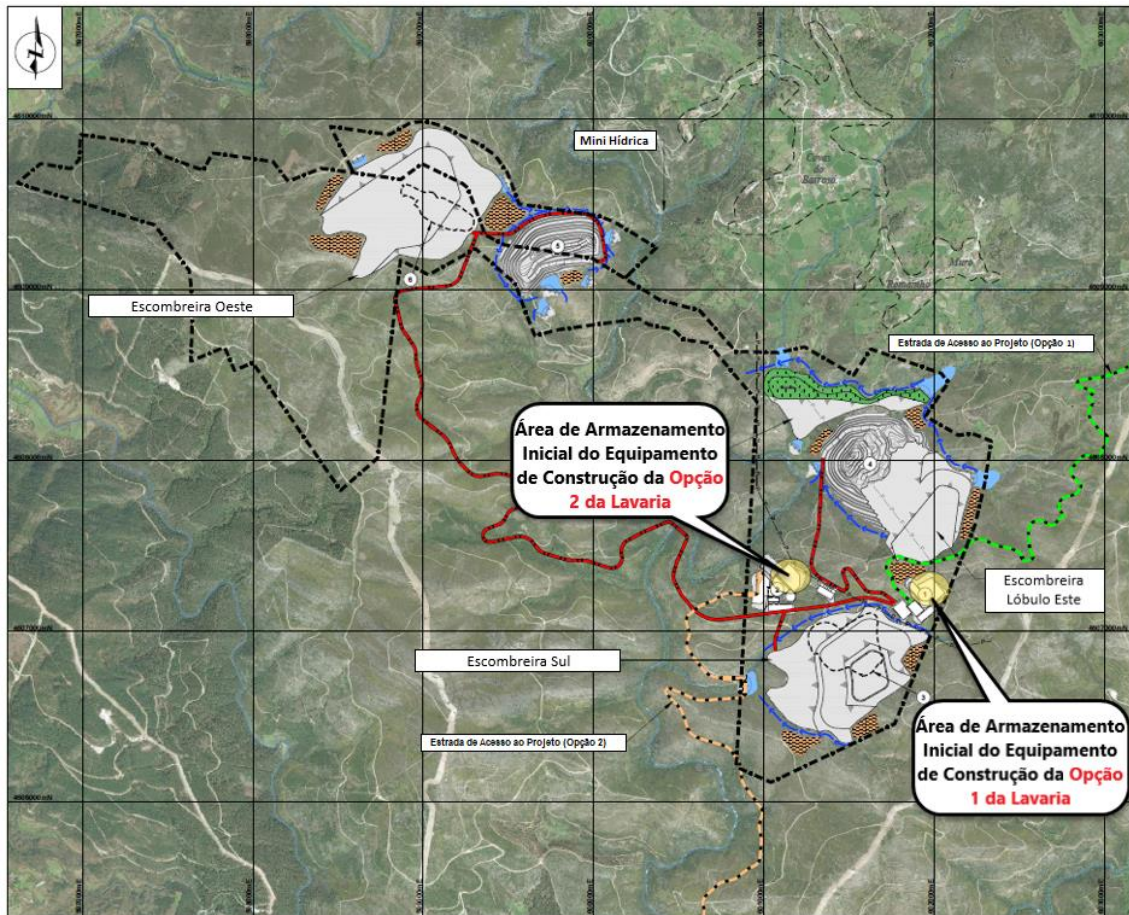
Pontos de Localização de Construção Inicial de Equipamentos.
